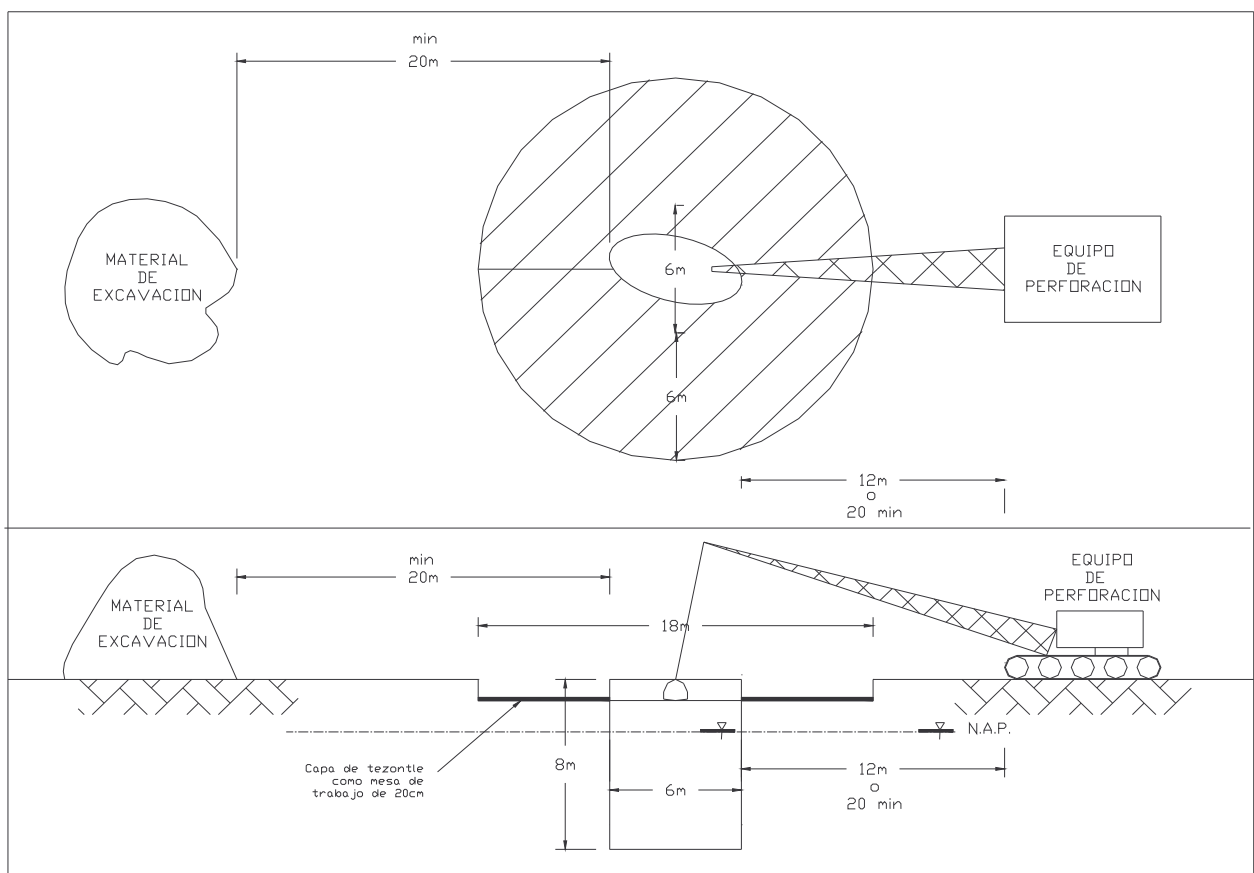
Dimensiones para excavación de alivio de cargas y disposición de equipo y material de excavación.
